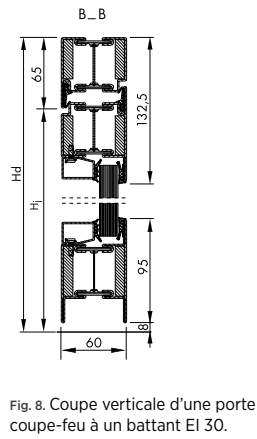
Coupe verticale d'une porte coupe-feu à un battant EI 30.
